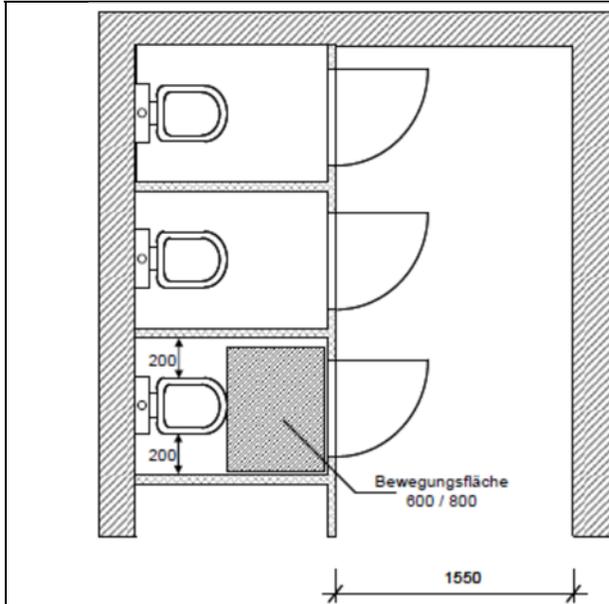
Einbündige Toilettenanlage, Türanschlag nach außen (Maße in mm)
